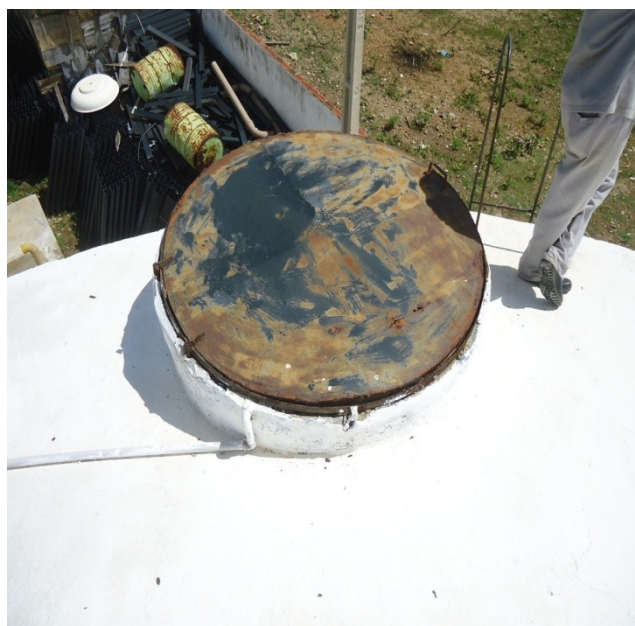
Tampa de inspeção RAP-02 enferrujada.
